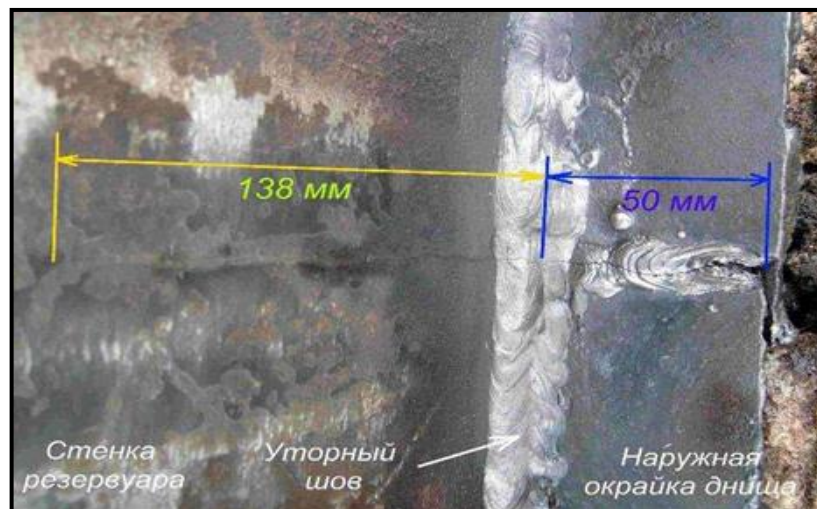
Трещина в сварном шве (вид с внешней стороны) [7]
